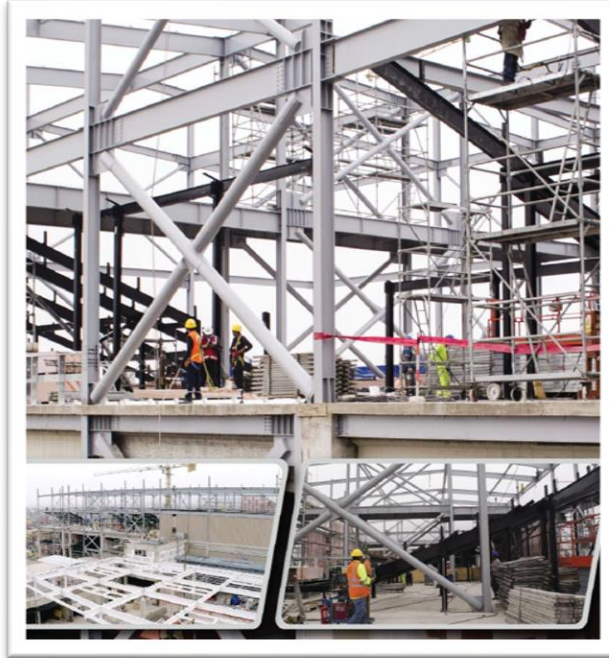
Proyecto CC Jockey Plaza. Diseño y Construcción JCB Estructuras 2013
